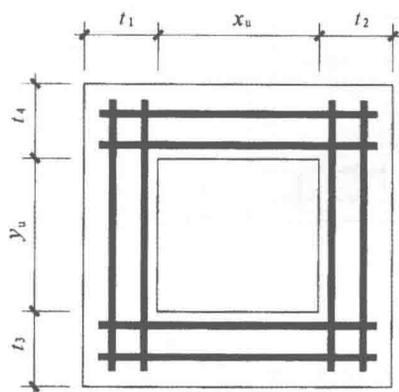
普通单杯口顶部焊接钢筋网片构造
